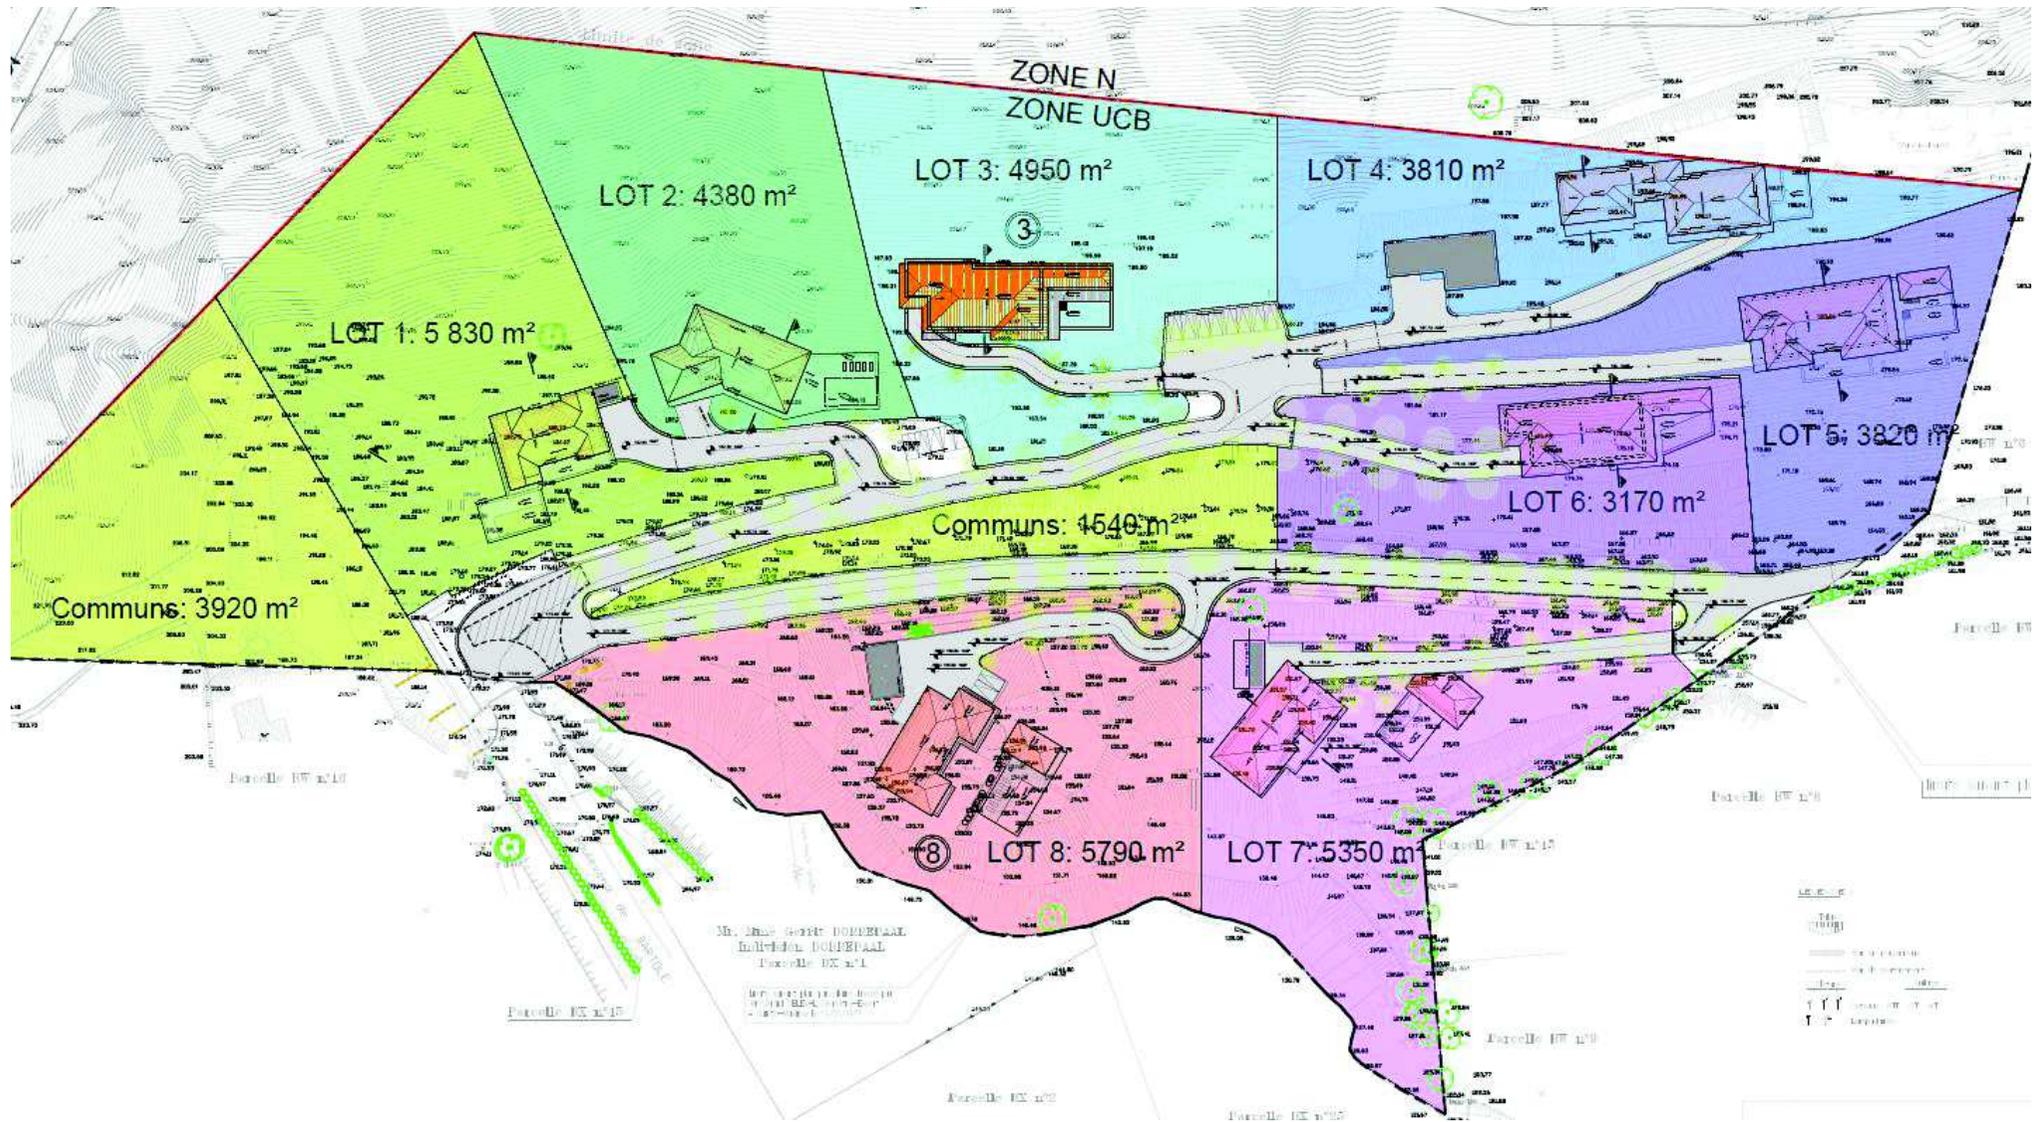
Plan masse de l'opération (source : Gilbert et associés architecte)
